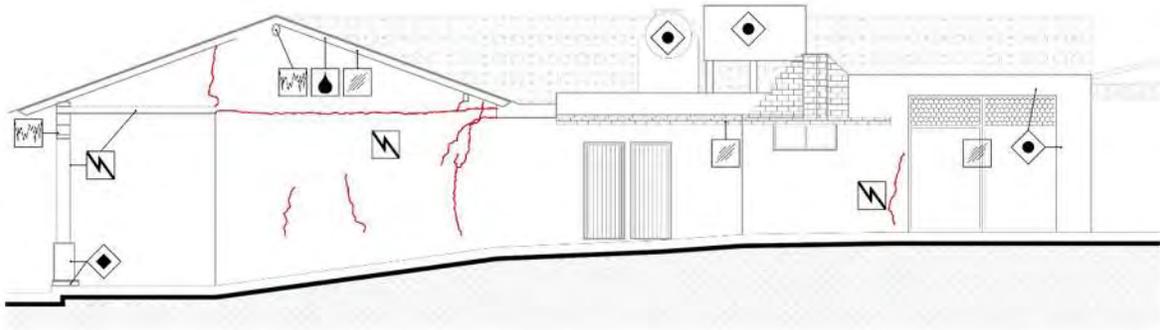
Croquis de fachada sur con los principales agrietamientos del muro piñón y las múltiples alteraciones. Elaboró: AMT.
